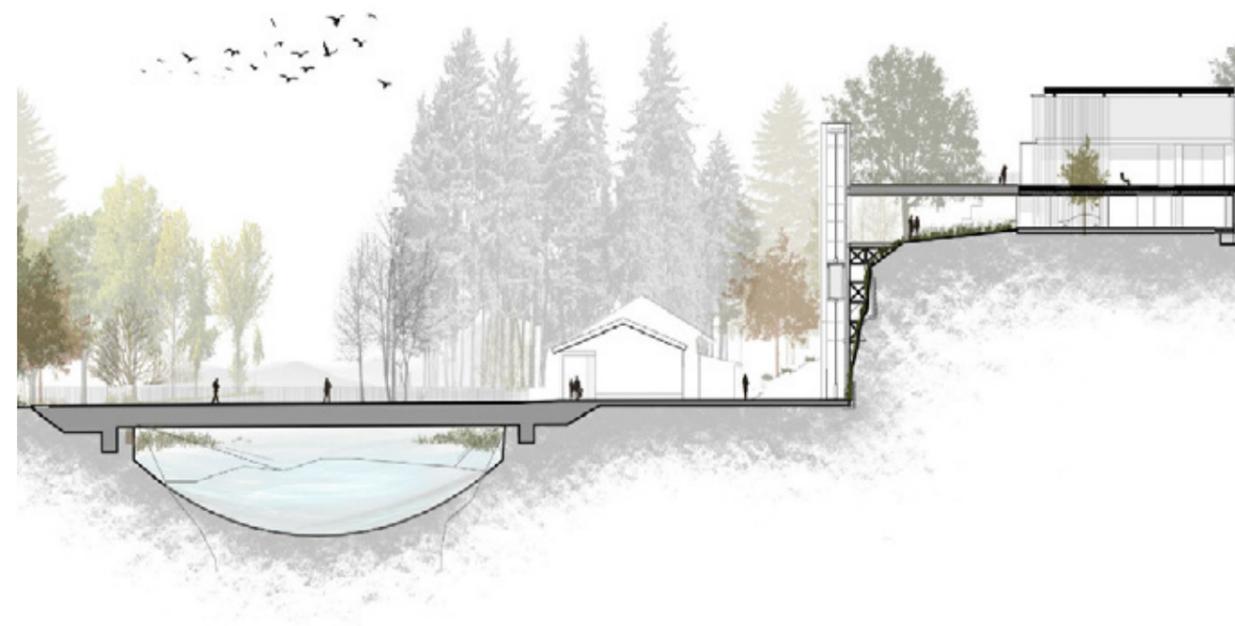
Propuesta de conexión. Fuente: Autoría propia (2023)
